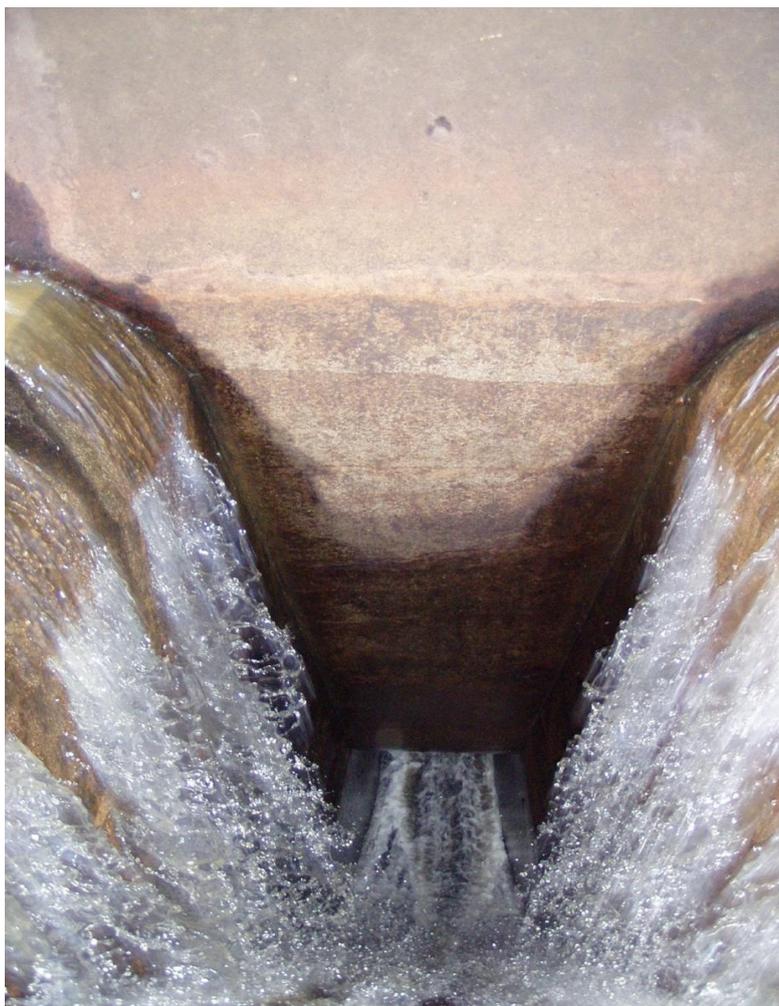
Vue de la tour tulipe et des entonnements – vue du socle béton et du toit de la galerie Travaux d'enduits d'étanchéification, 2006 visibles
